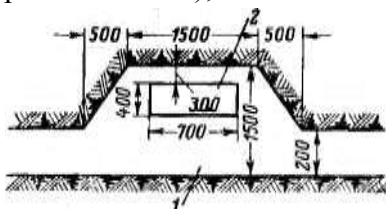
Котлован для монтажа соединительной муфты на напряжение до 10 кв.
